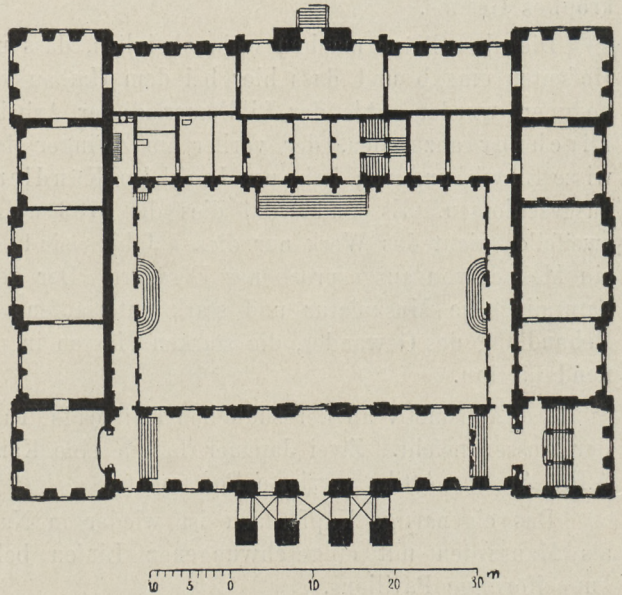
Japanisches Palais. Grundriss des Erdgeschosses.
